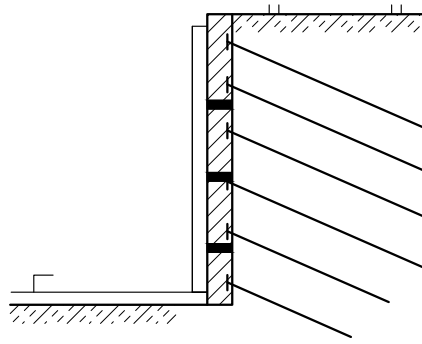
Кріплення стін виробки забиванням стержнів та кріплення до них дерев'яних щитів
